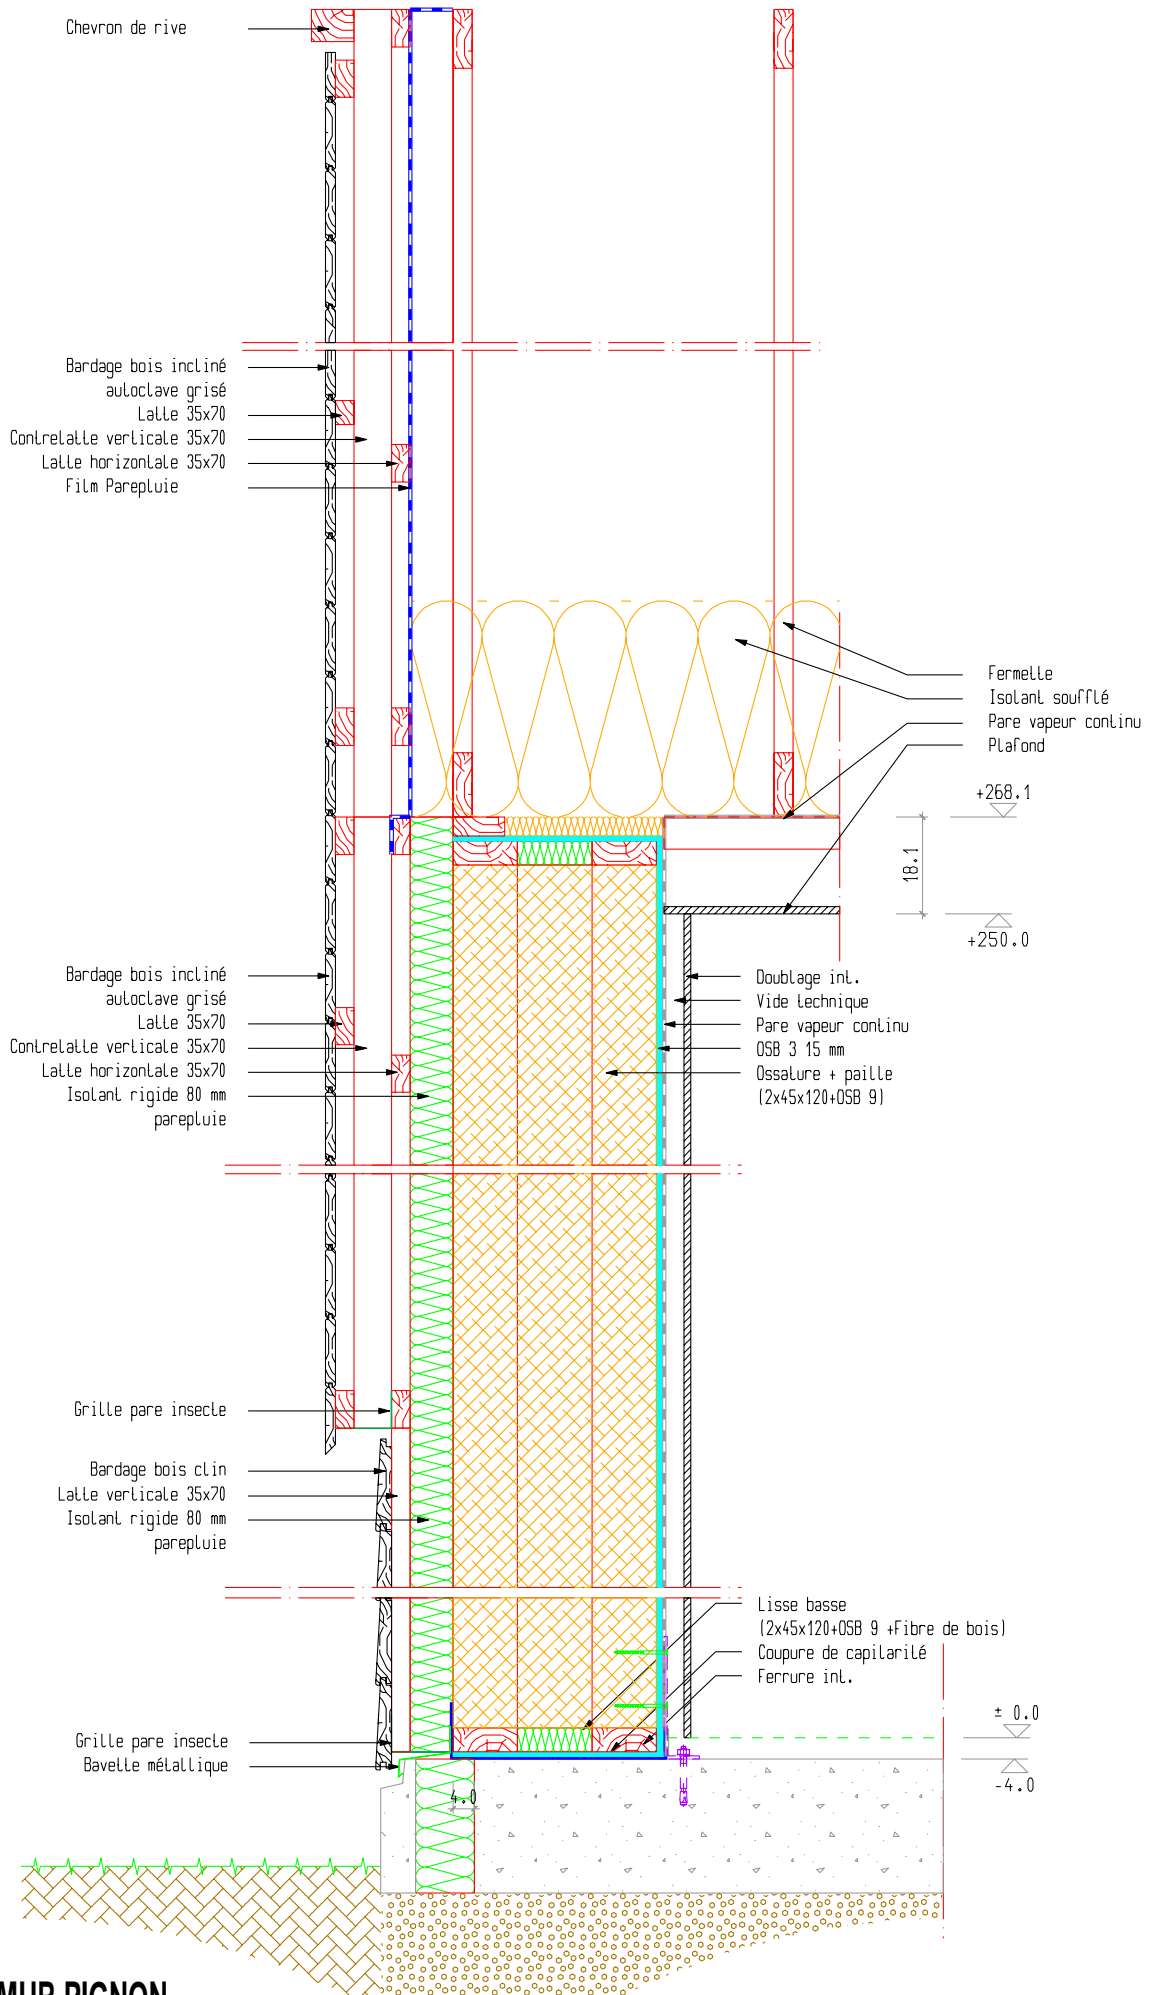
DETAIL MENUISERIE MUR PIGNON - BARDAGE INCLINE
